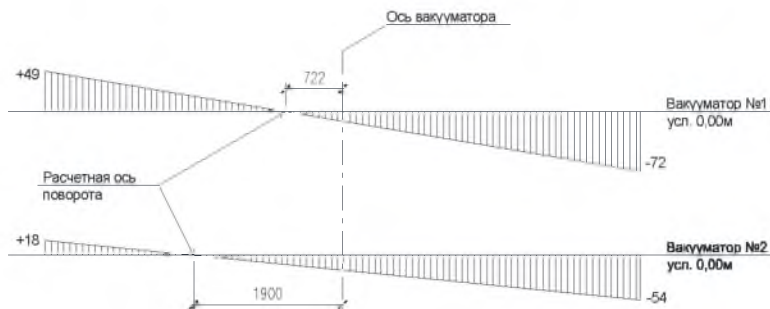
Схема крена фундаментной плиты вакууматоров №1 и №2
